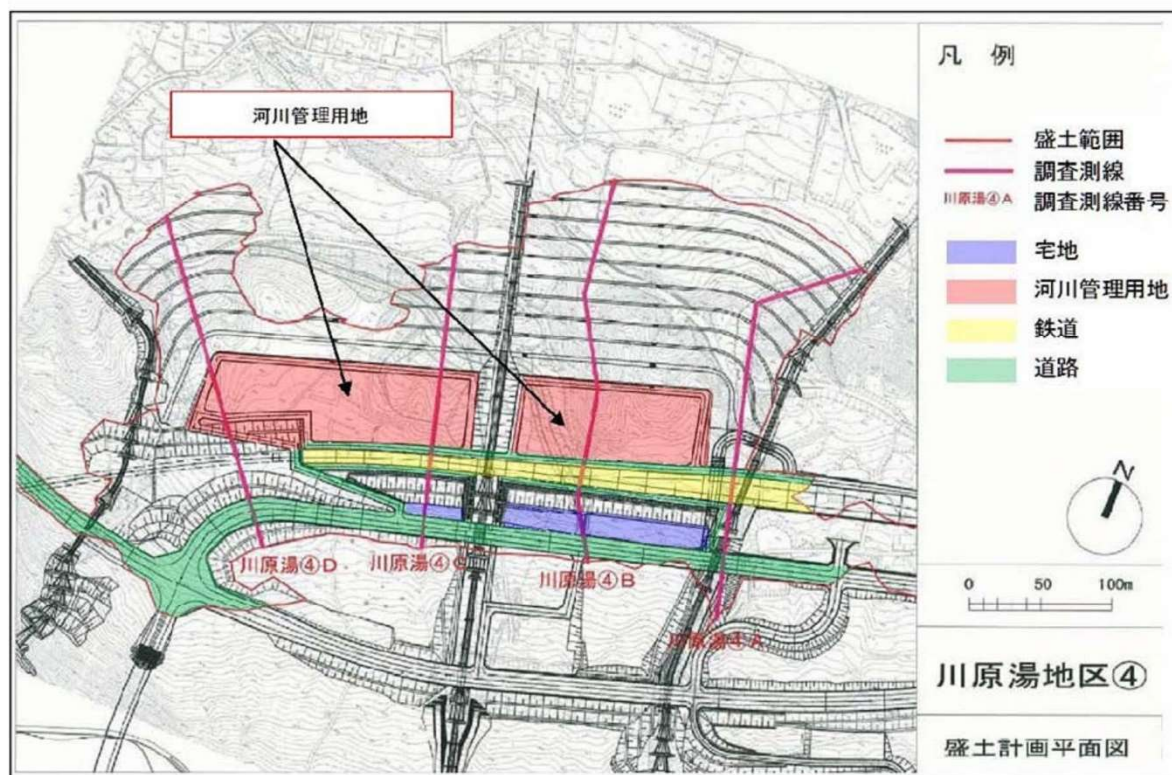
川原湯地区④(上湯原地区) 計画平面図
